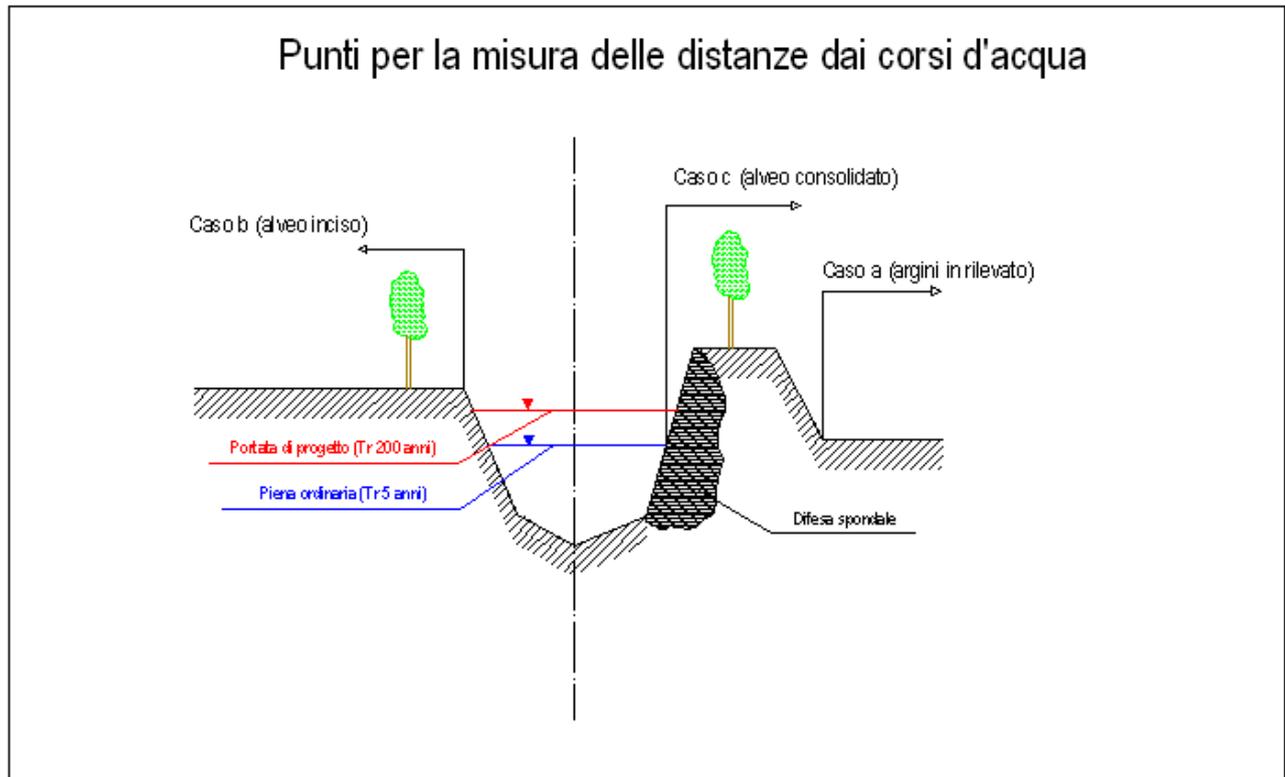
Sezione tipo di alveo fluviale con individuazione dei punti per la misurazione delle distanze.
